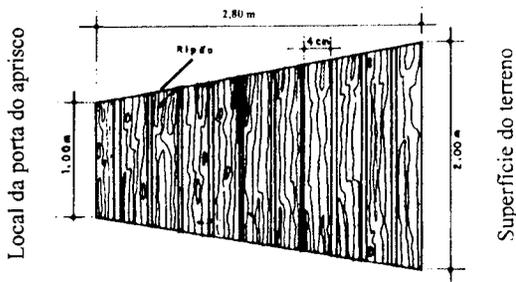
Detalhes da rampa do aprisco, vista de cima.
